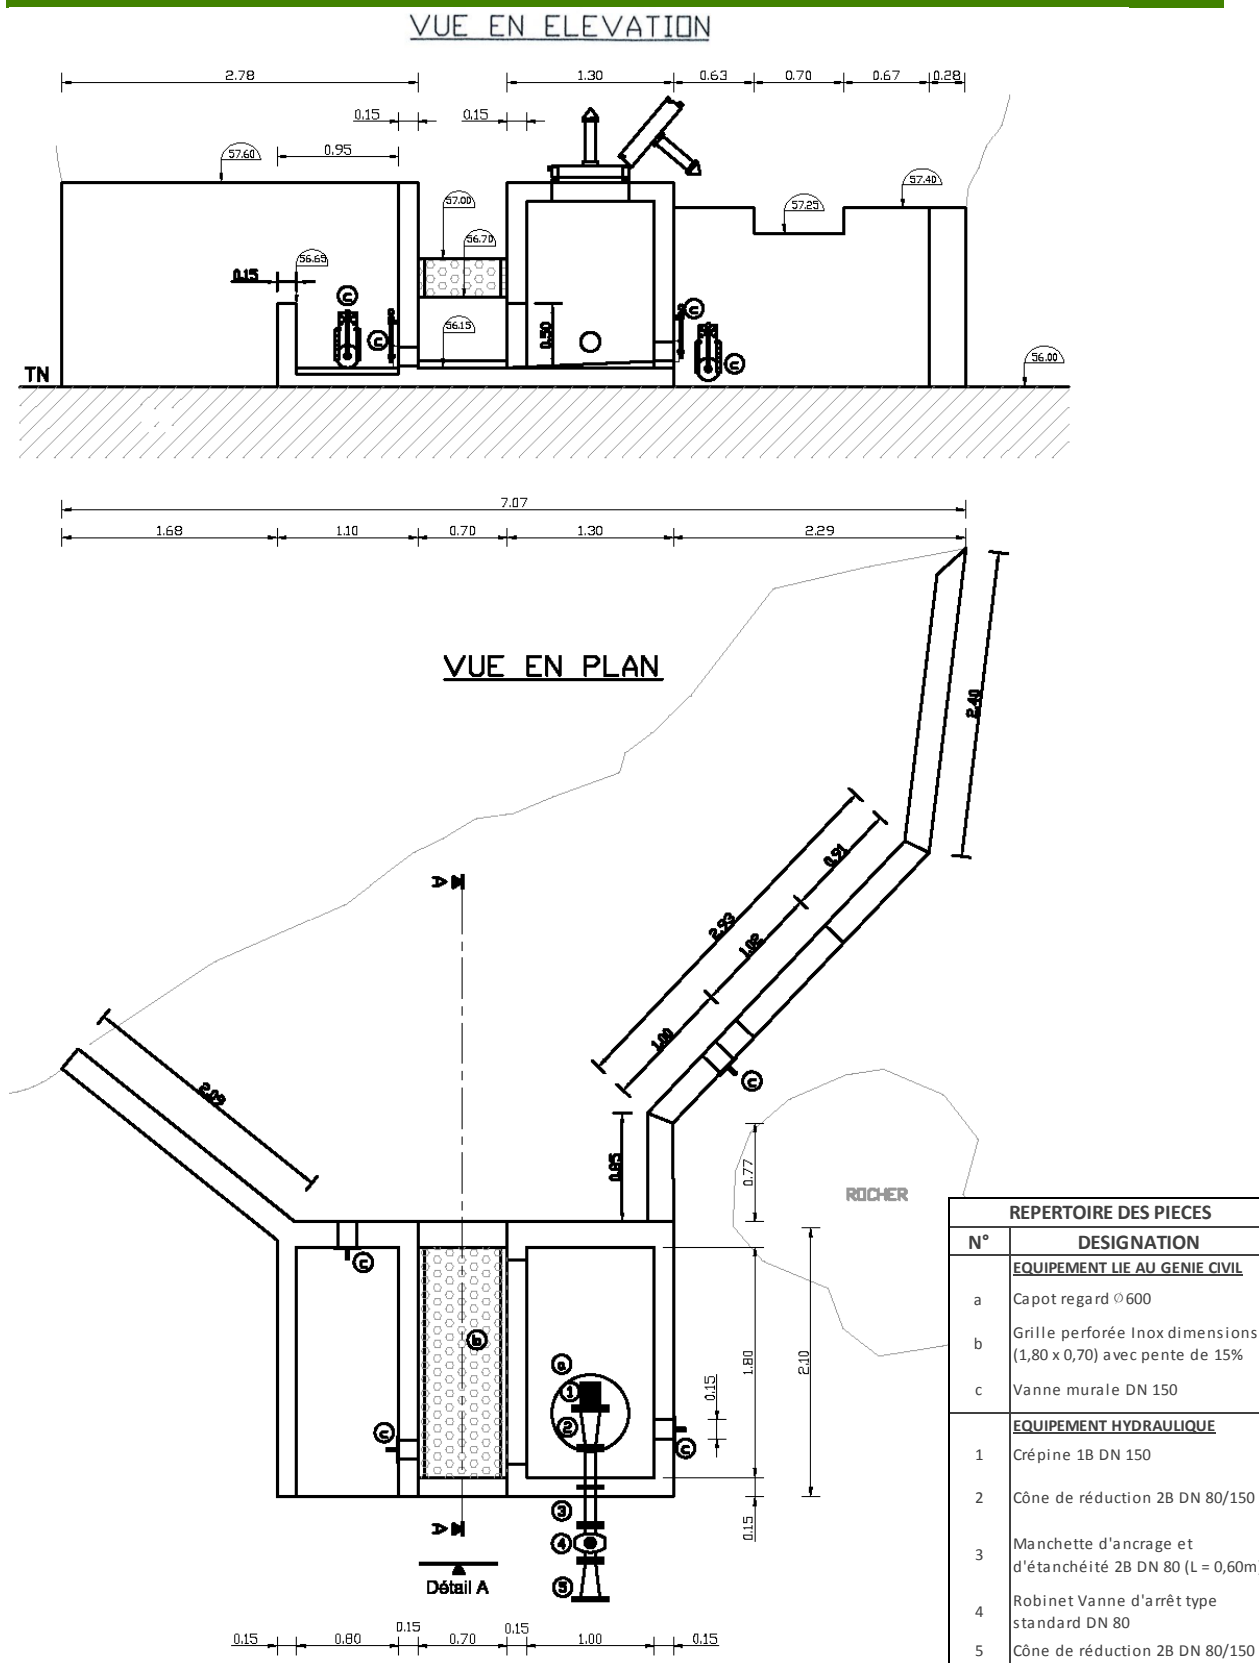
Plan du captage vue en coupe et vue en plan. (Source IDR)
